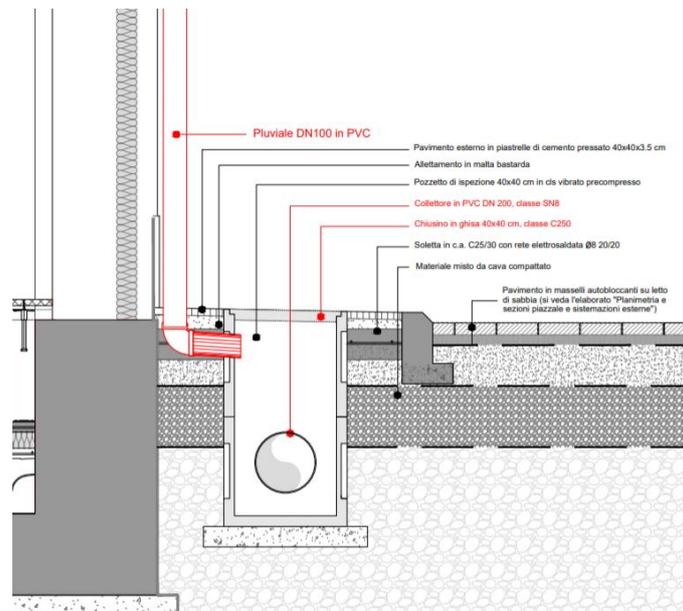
Dettaglio collegamento pluviale-pozzetto
